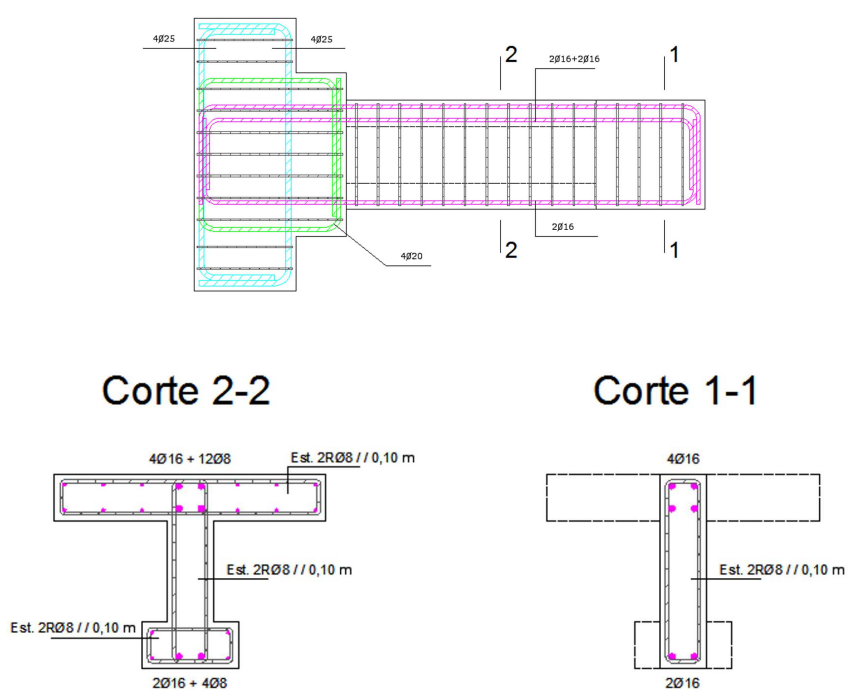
Pormenorização das armaduras do modelo, em alçado (cima) e em cortes (baixo). Adaptado de [34].
